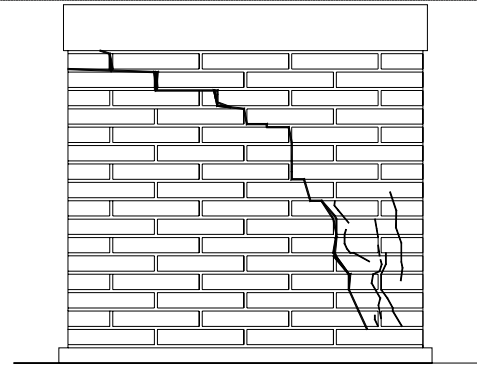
Detalle de fisura en uno de los paneles intactos (Sánchez, 2001).
